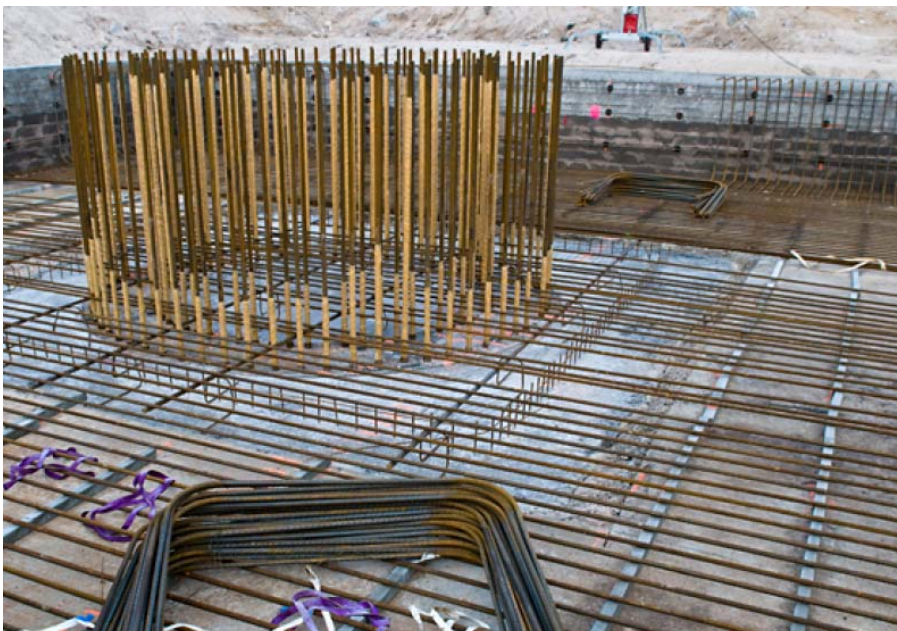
Bottenförankring är ingjuten i 40 cm betong. Underkantsarmering påbörjad.
